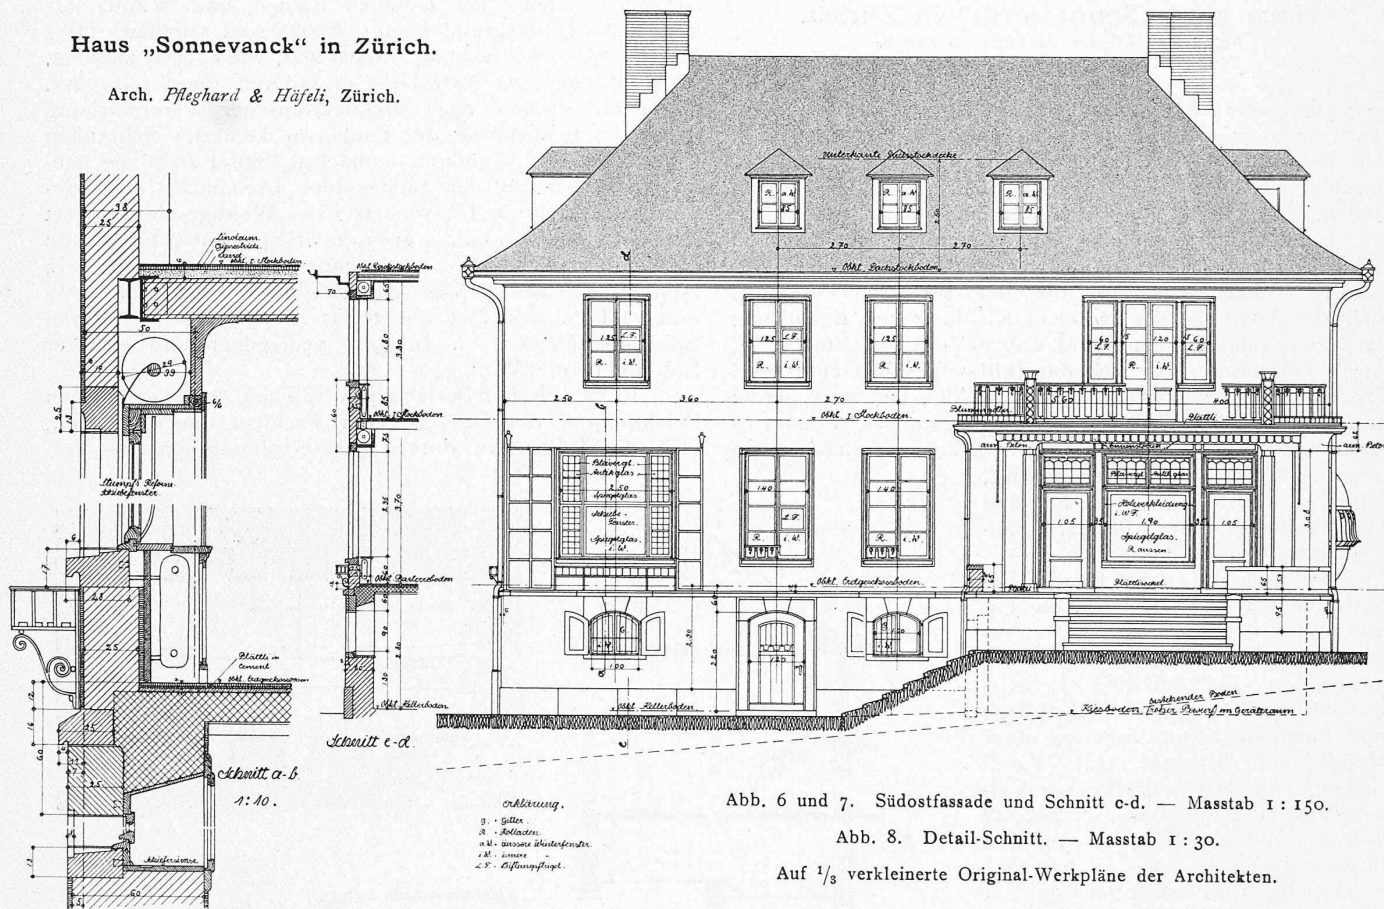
und 7. Südostfassade und Schnitt c-d. — Masstab 1:150.
